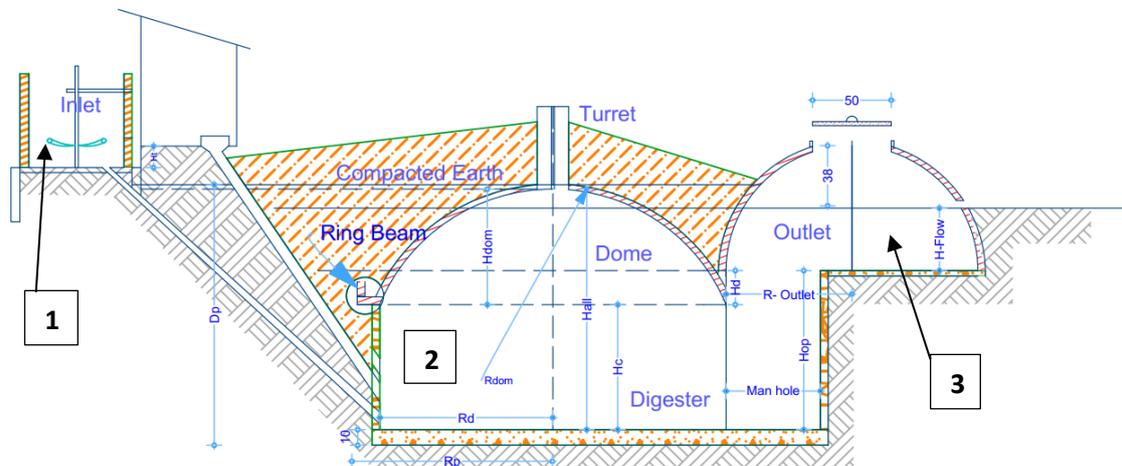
plan de construction d'un digesteur domestique à dôme fixe tel qu'installé par le programme FONERWA au cours de l'année 2017. Selon les plans originaux, ces plans sont adaptés de 4 à 10 m³. Source [9].
